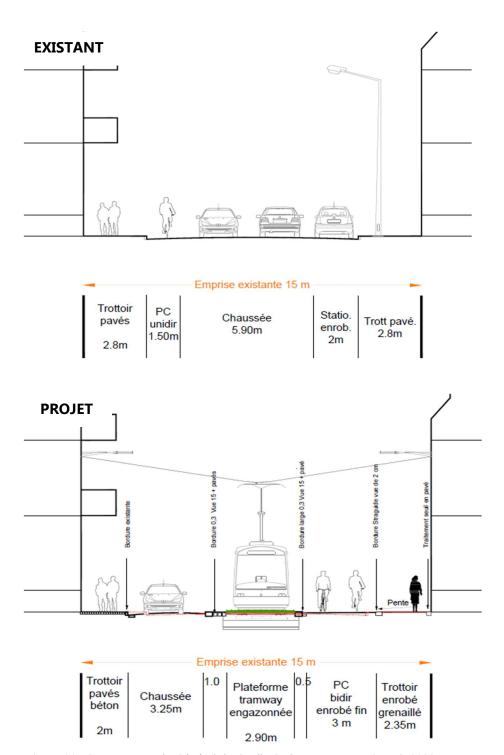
Coupe Route du Général de Gaulle Sud (source : AVP GETAS, 2023)
